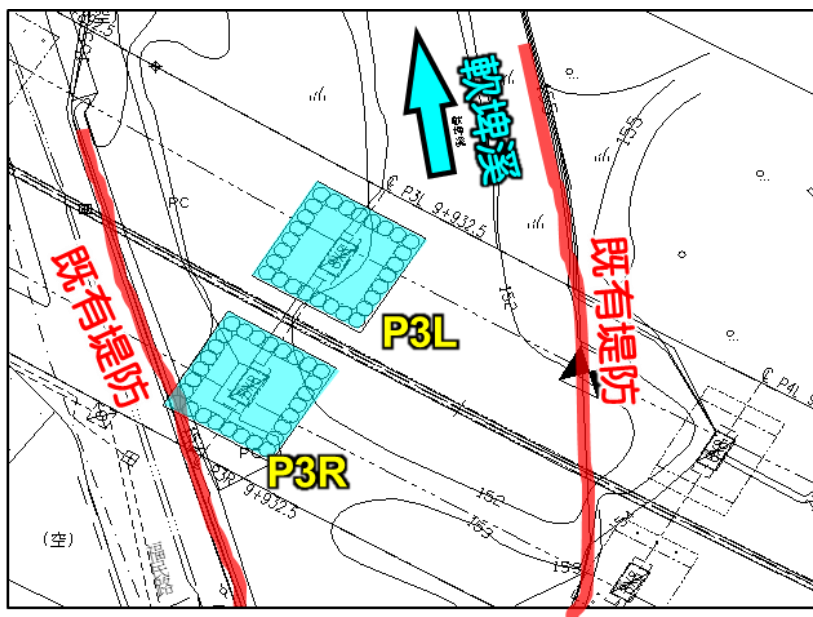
軟埤仔溪豐原高架橋平面圖(補強後)
